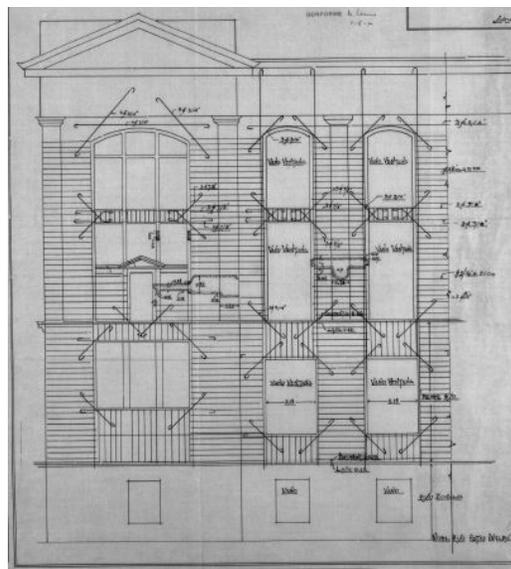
Detalle fachada sector nororiente Palacio de Tribunales. Fuente: Archivo DEPA MOP
